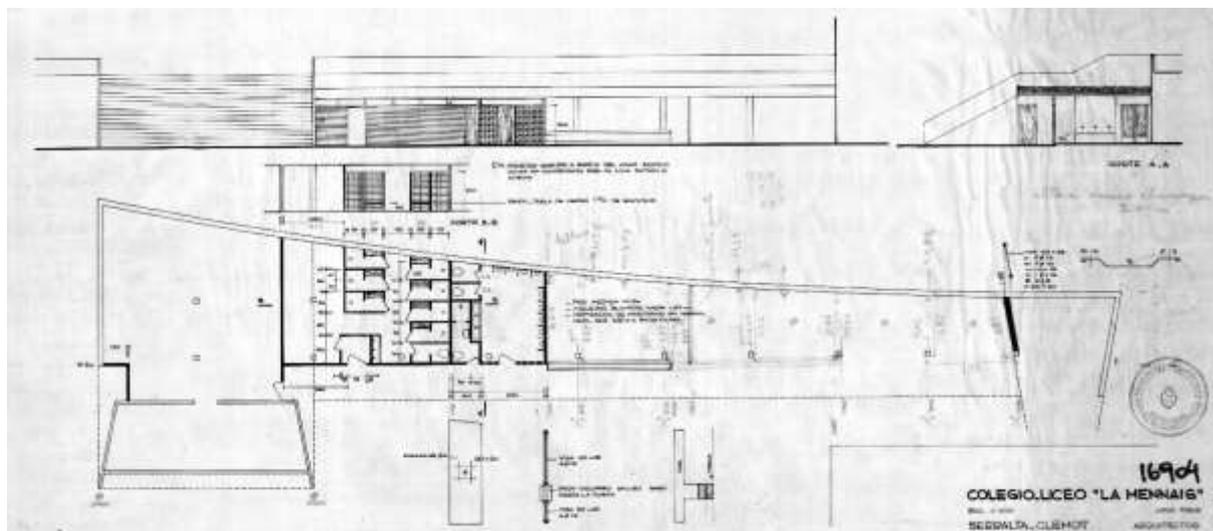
/ 1968- Plano del sector contra Otelo – Lám 16.904 DDI-IH
